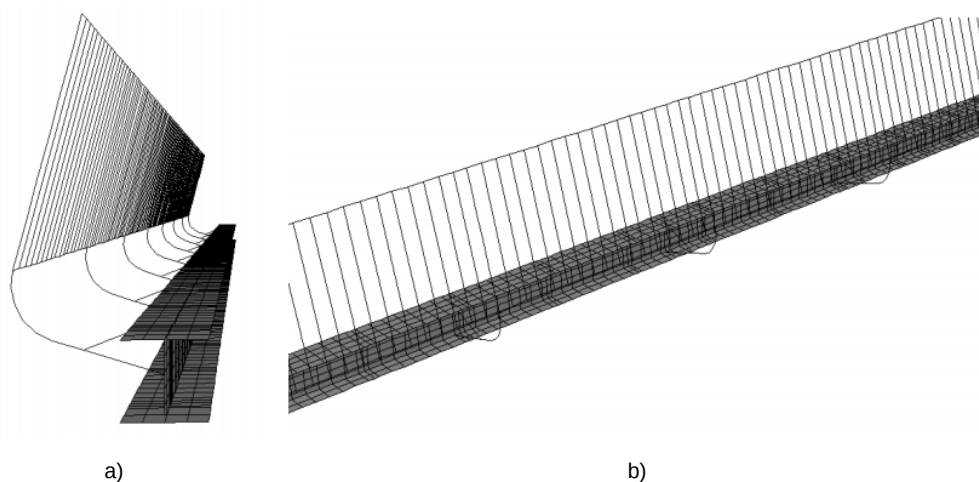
Protótipo estrutura a) Guarda e viga de aço (Vista y-z), b) vista 3d de uma viga e respetiva guarda de segurança painéis (Martinho, 2013).
